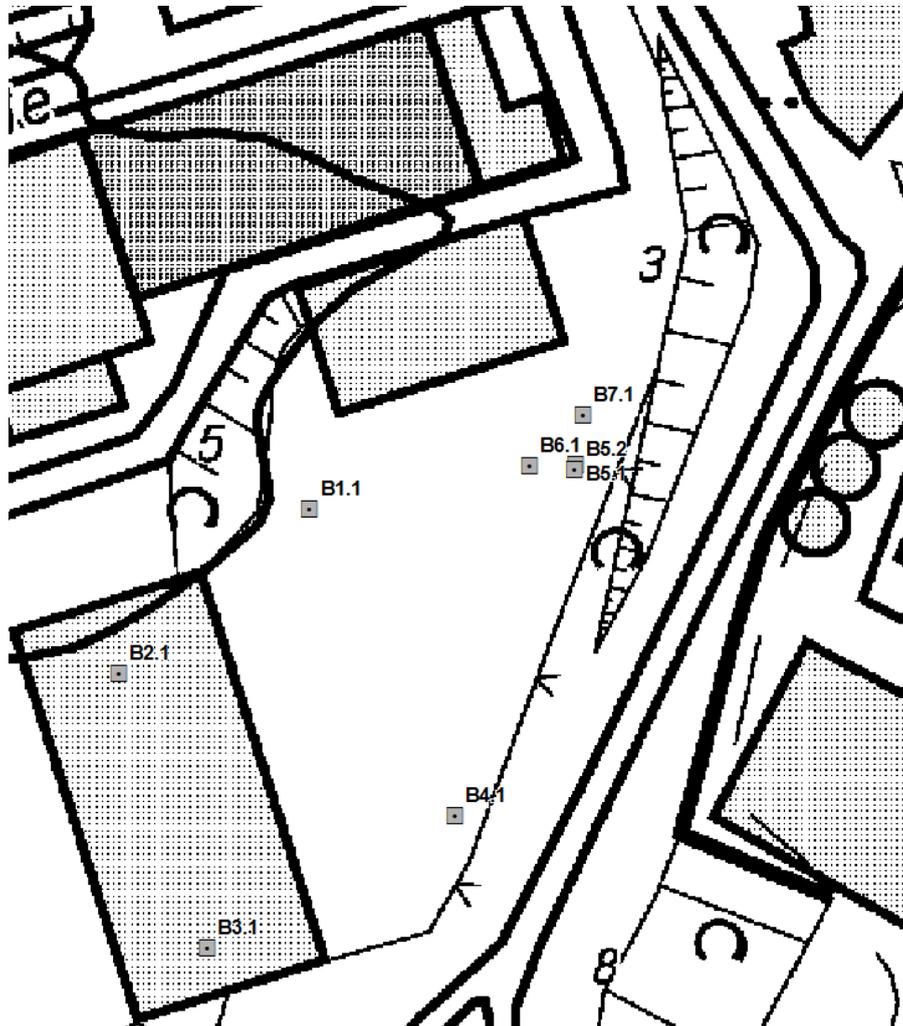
Lageplan der Untersuchungspunkte B5.2 – B7.1 zur Erkundung der oberflächennahen Böden im Bereich Bohrung B5.1 – Nachuntersuchung
